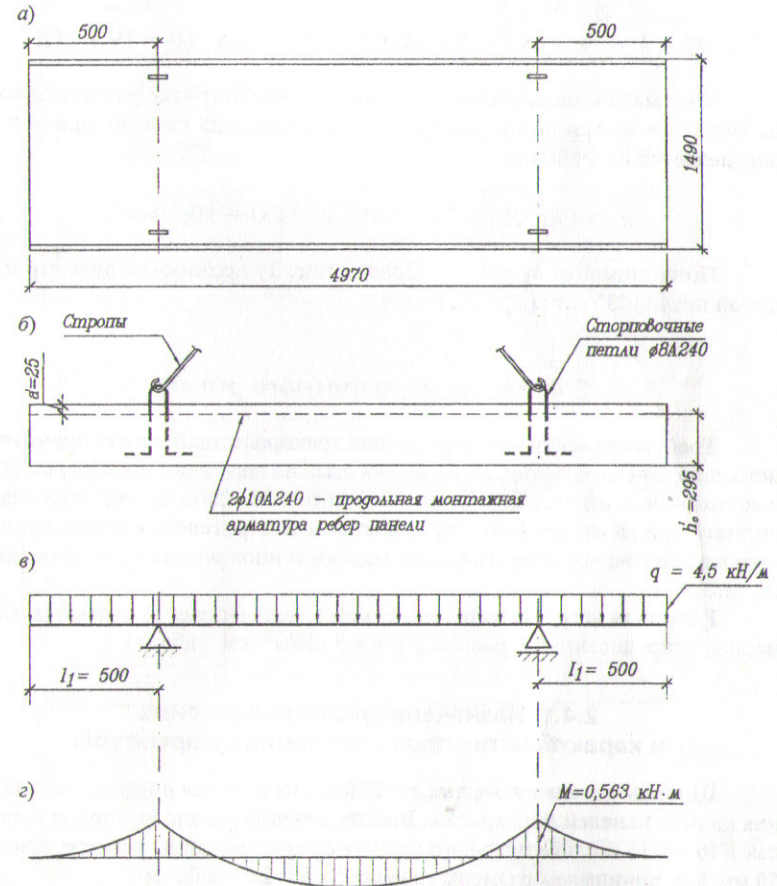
Схема к расчету прочности сборной панели перекрытия на нагрузки, возникающие во время транспортирования и монтажа: а – план панели; б – схема строповки; в – расчетная схема; з – эпюра моментов
